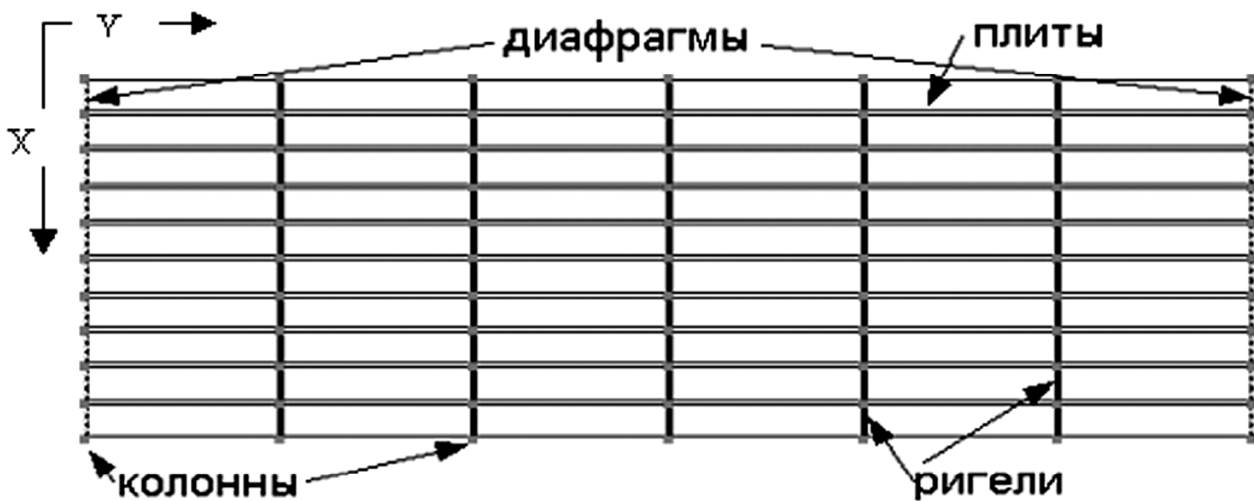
Каркасное сборно-монолитное здание с продольной раскладкой плит
